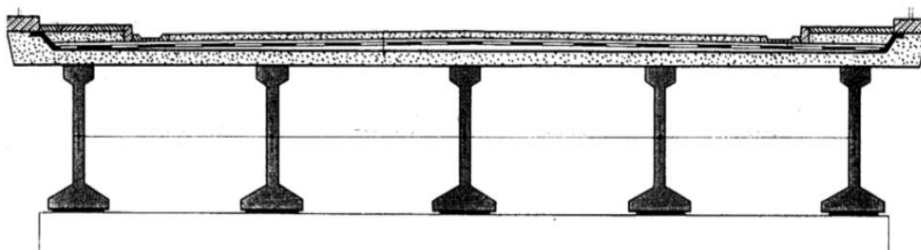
Coupe transversale d'un pont à poutres préfabriquées
